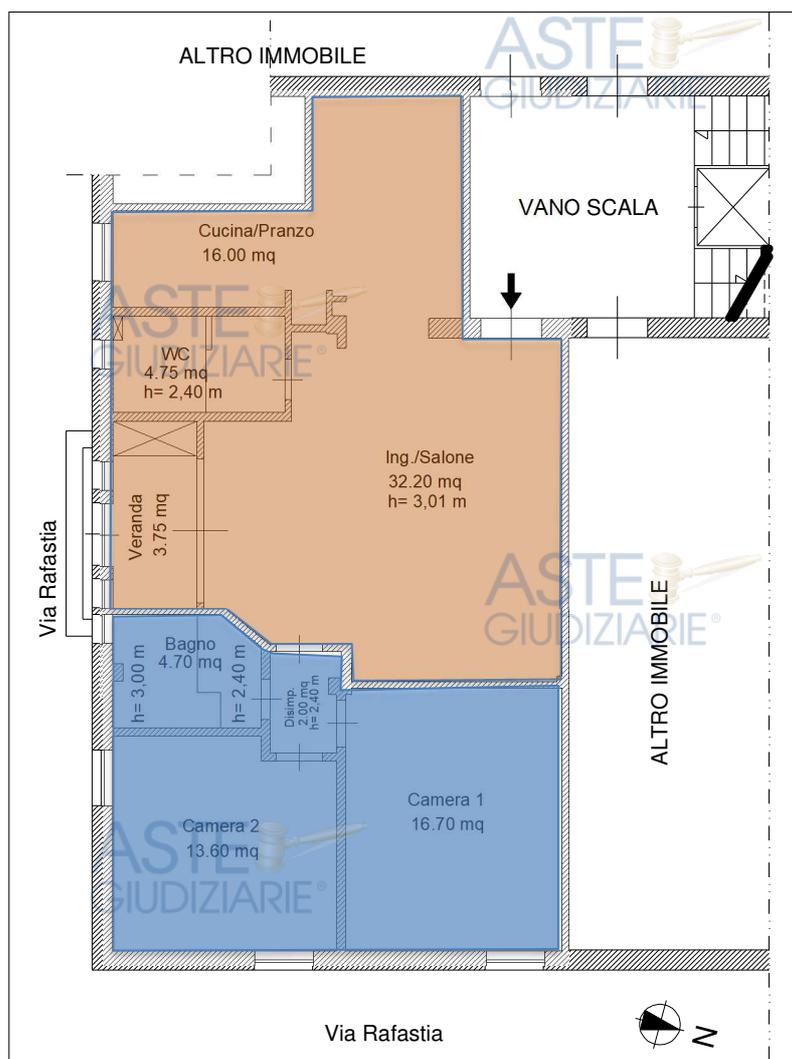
Pianta dell'abitazione pignorata – piano terzo
